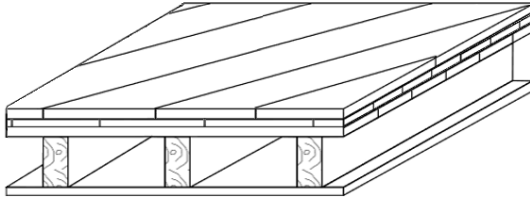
Pojačanje stropne konstrukcije izvedbom tlačne ploče i povezivanje sa zidovima
